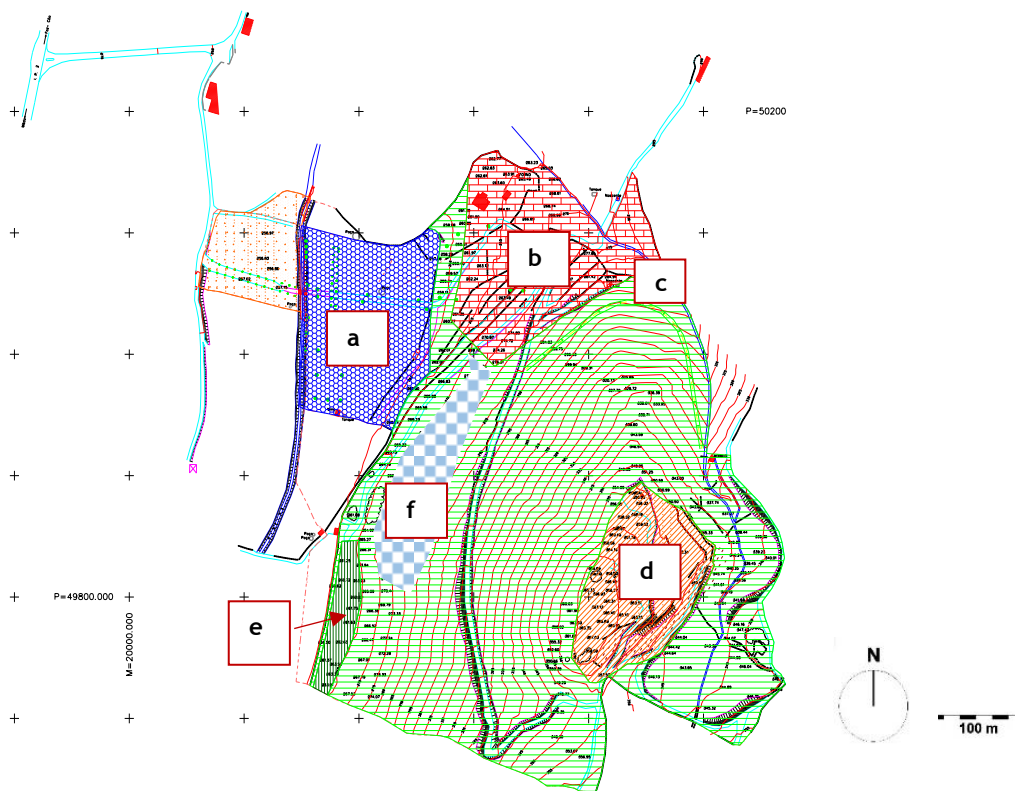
\_ Planta de zonamento de aplicações (a partir de CR,2015).
